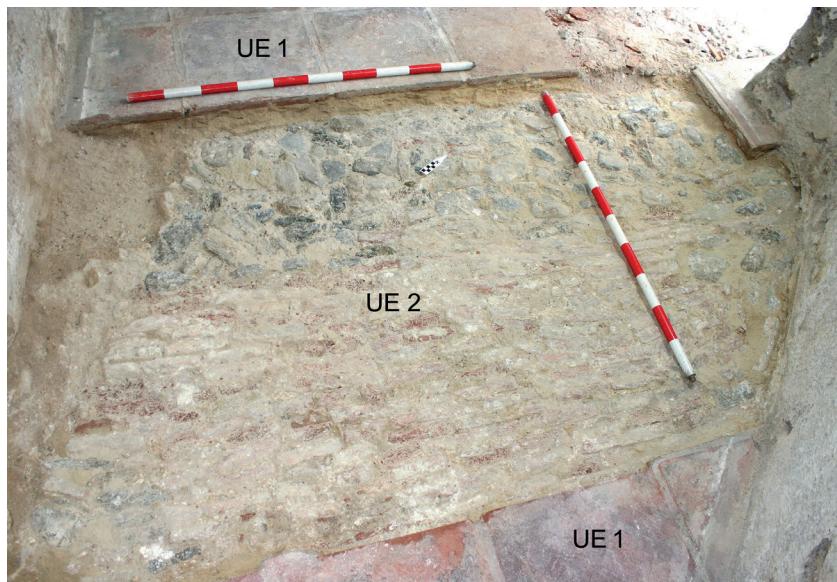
Pavimento mixto de empedrado y fragmentos de ladrillo y losas (UE 2) dispuestos por el canto, bajo pavimento de losas cerámicas (UE 1). Ambos corresponden a la Edad Contemporánea.
